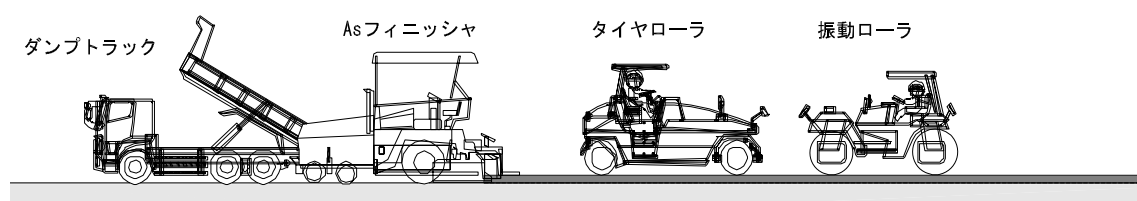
アスファルト舗装工（表層）の施工状況
